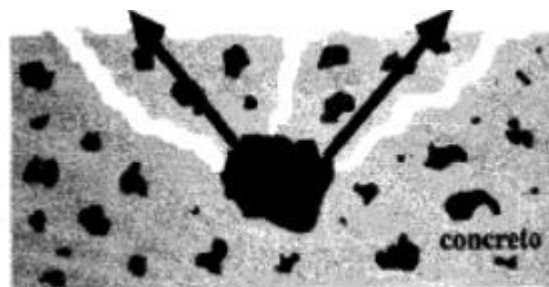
Representación de fisuras por acomodamiento plástico.
